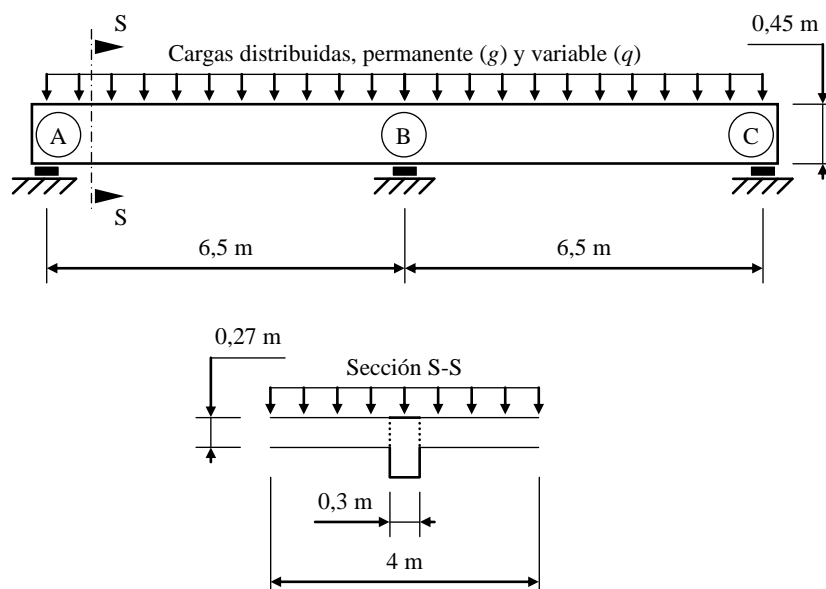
Viga continua de dos vanos de hormigón armado.
